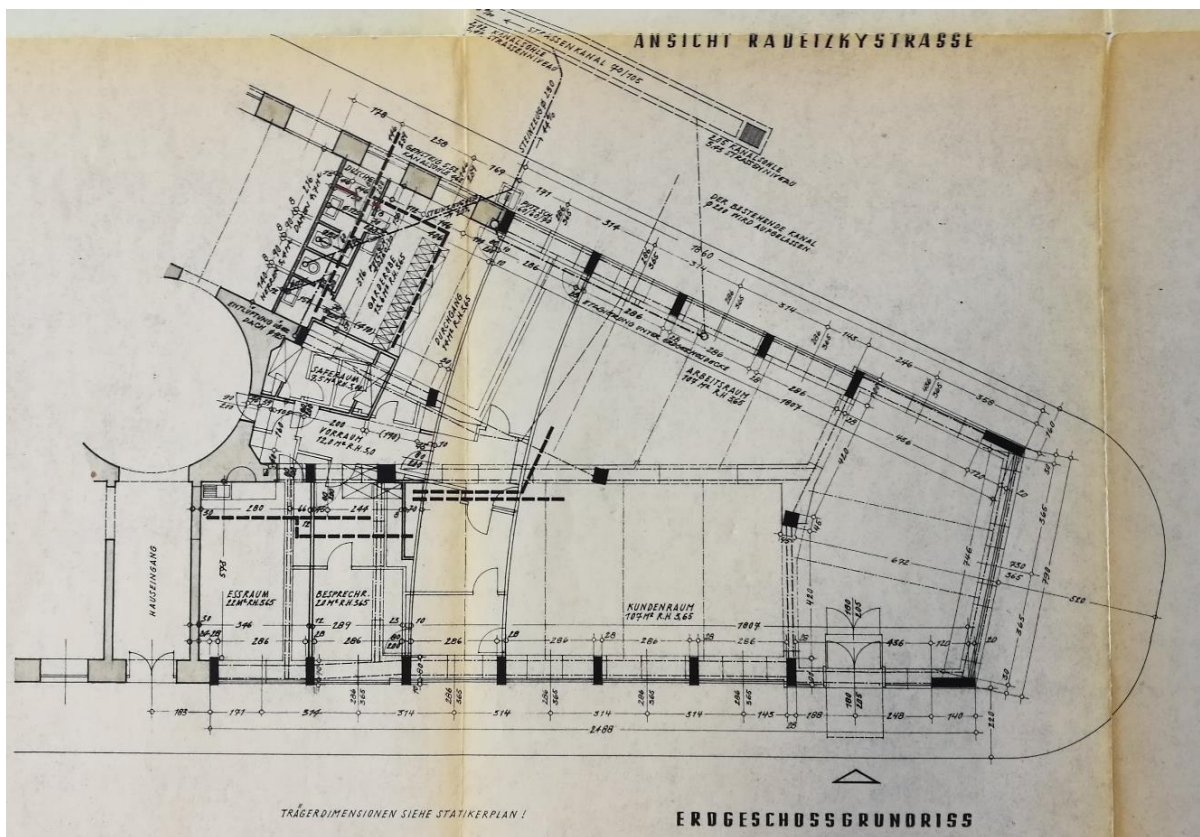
Grundriss Erdgeschoß, Einreichplan vom 1. Umbau, Radetzkyplatz, Hans Hohenegger, 1961
